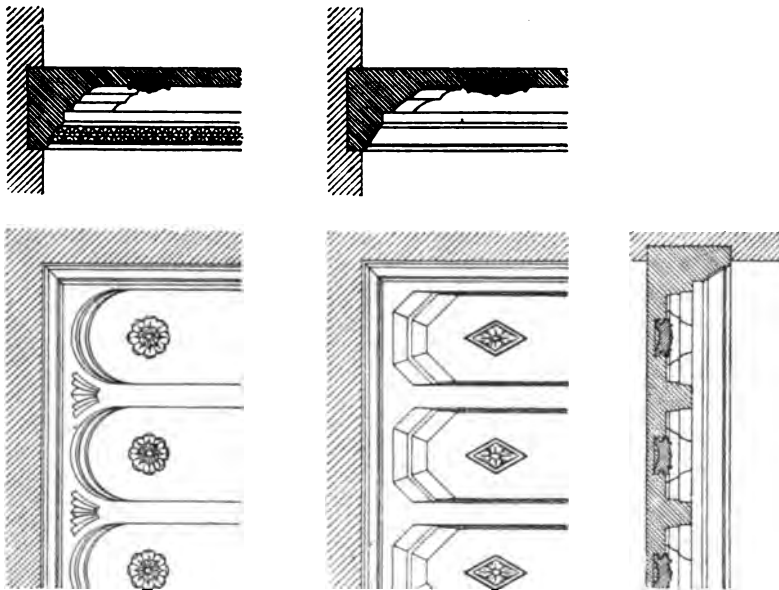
Durch Einlagen verzierte Plattenbalkendecken.
